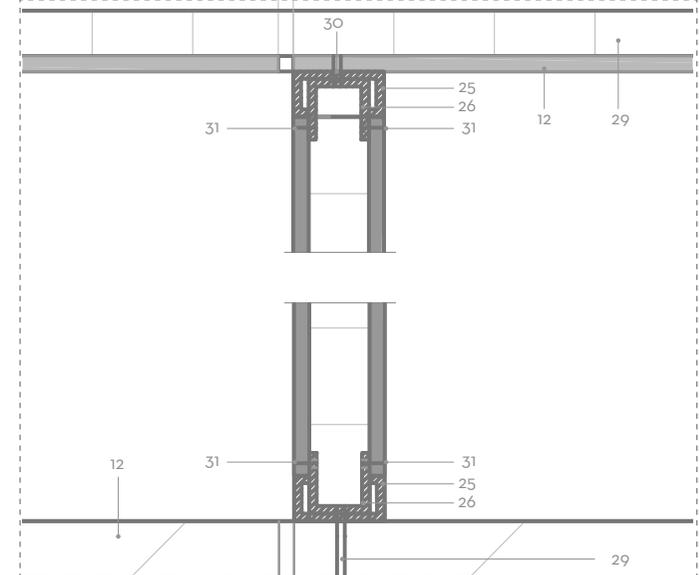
Arriba: Det_e05 Anclaje superior de panel prefabricado. Escala: 1,5
